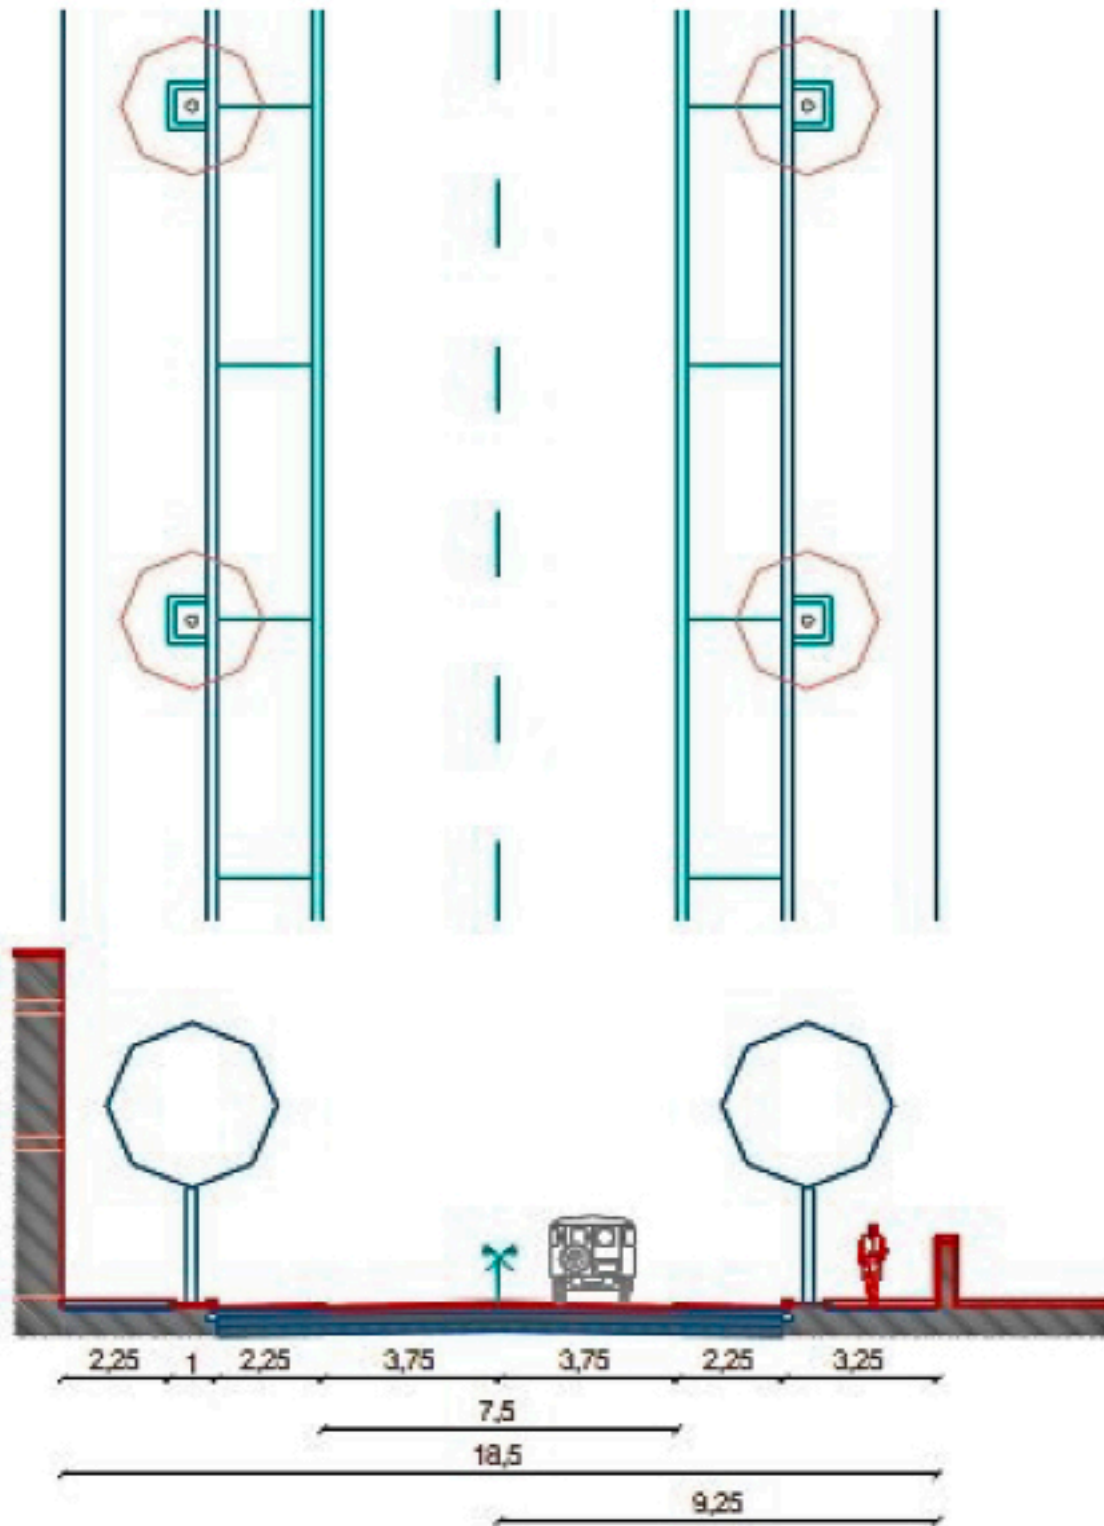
Perfil Transversal Tipo PT3 – Vias municipais simples em áreas de Habitação, Comércio e Serviços
